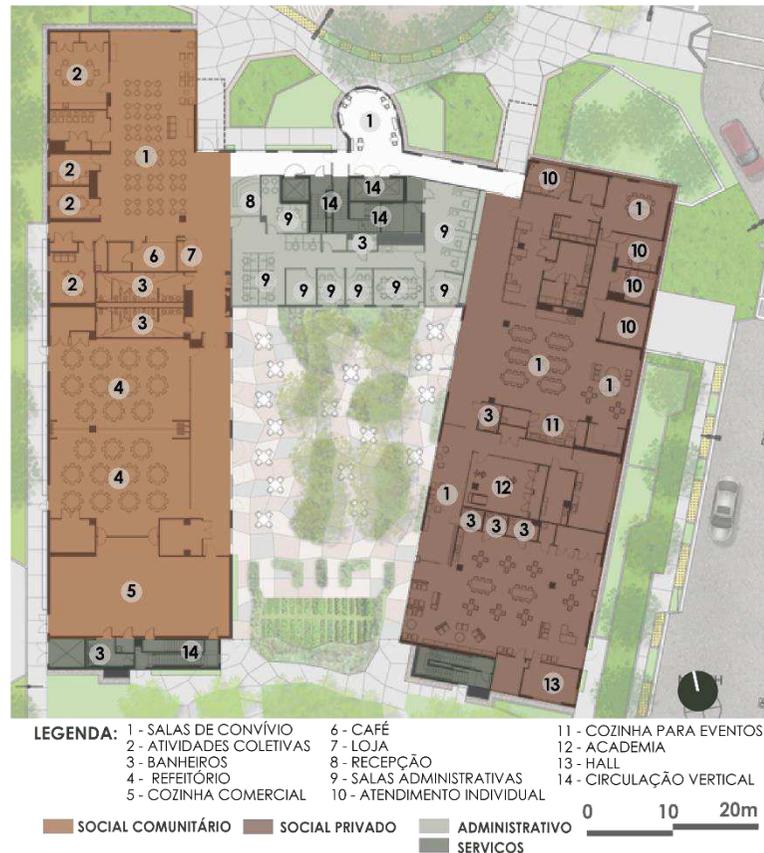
Planta baixa zoneada - Pavimento térreo.
